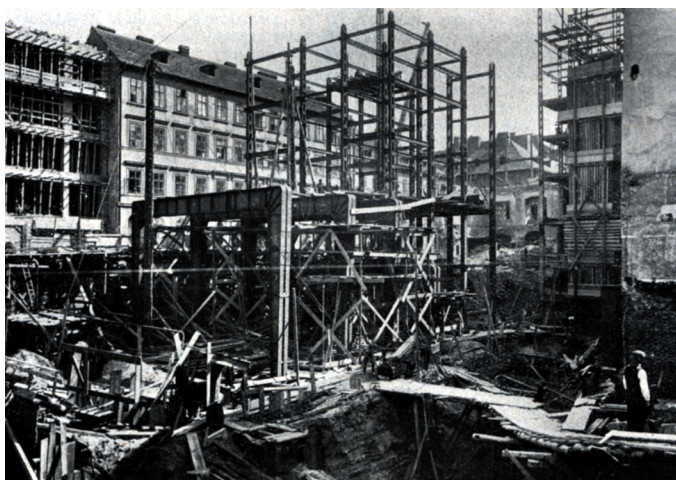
Železobetonová konstrukce pátého a šestého patra paláce Lucerna, 1910. Zdroj: *Český svět 1910*, Praha 1957.
